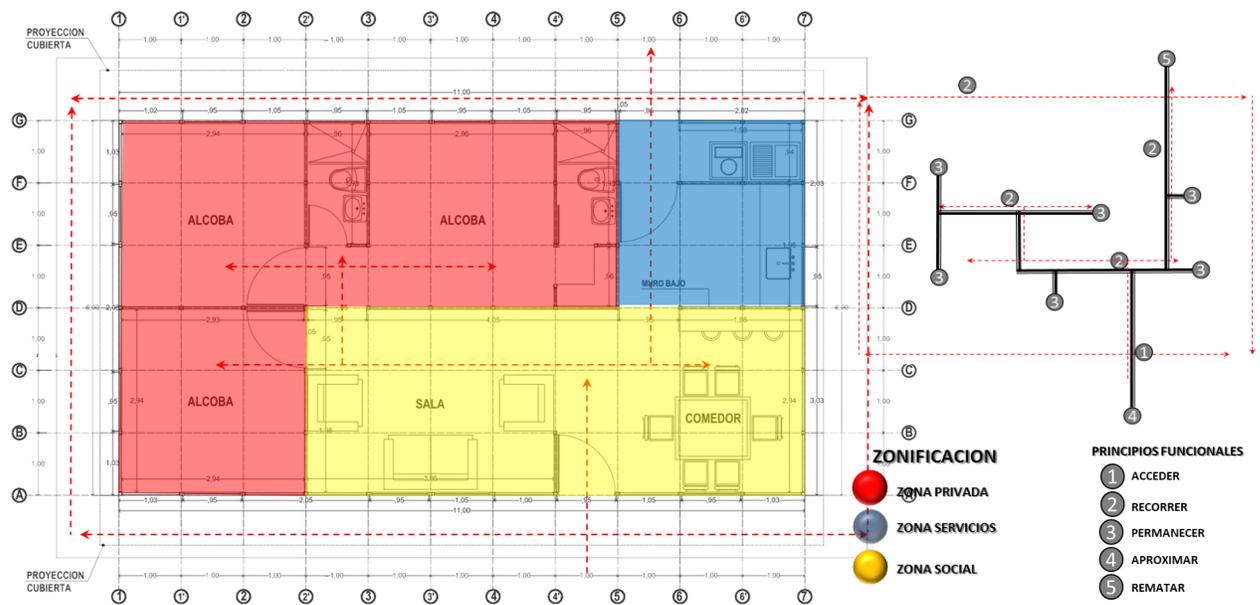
Planta Distribución Vivienda Rural 66m<sup>2</sup>, Fuente: Elaboración propia.
